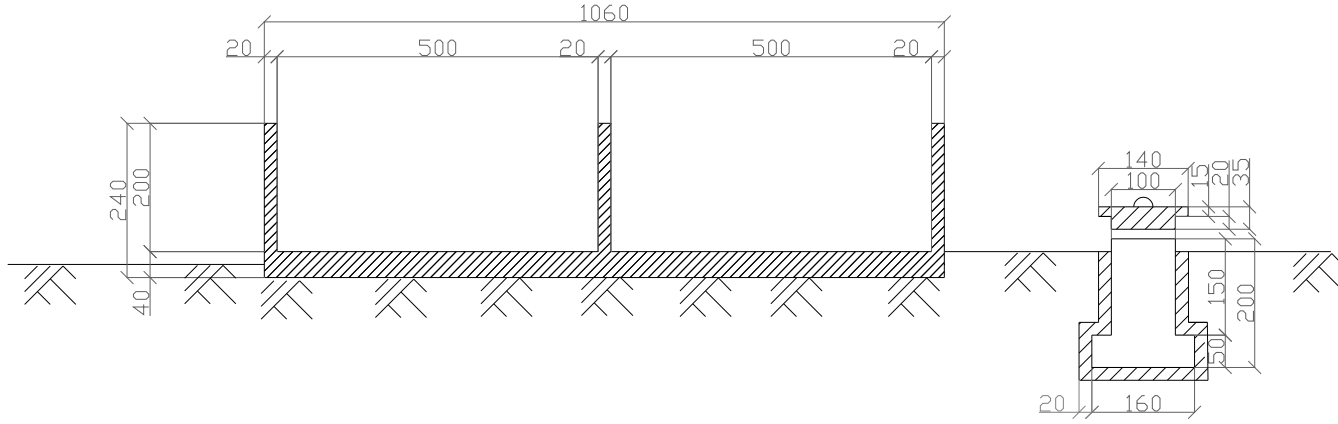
Toprak üstü gübrelik taban planı (20 başlık ahırlar için)
